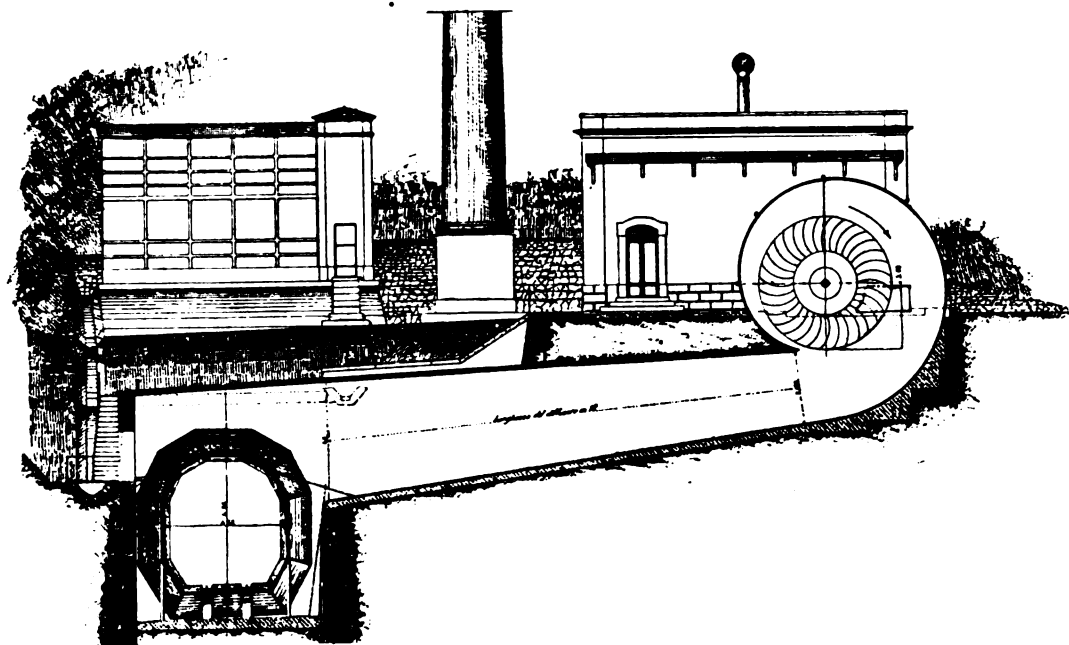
Officina per la ventilazione della galleria di Pracchia - Sezione nell'asse del diffusore.
